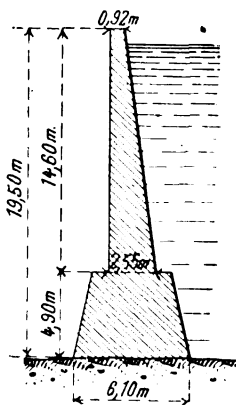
Profil du barrage-voûte de Bear Valley.
